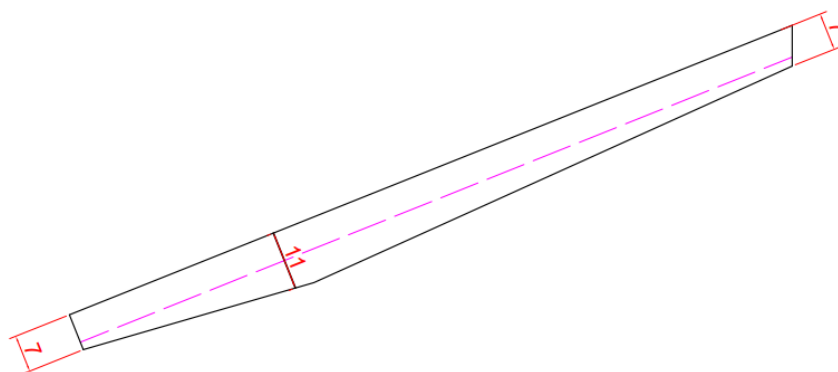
Configuração geométrica da viga de cobertura do pórtico, dimensões em cm.
